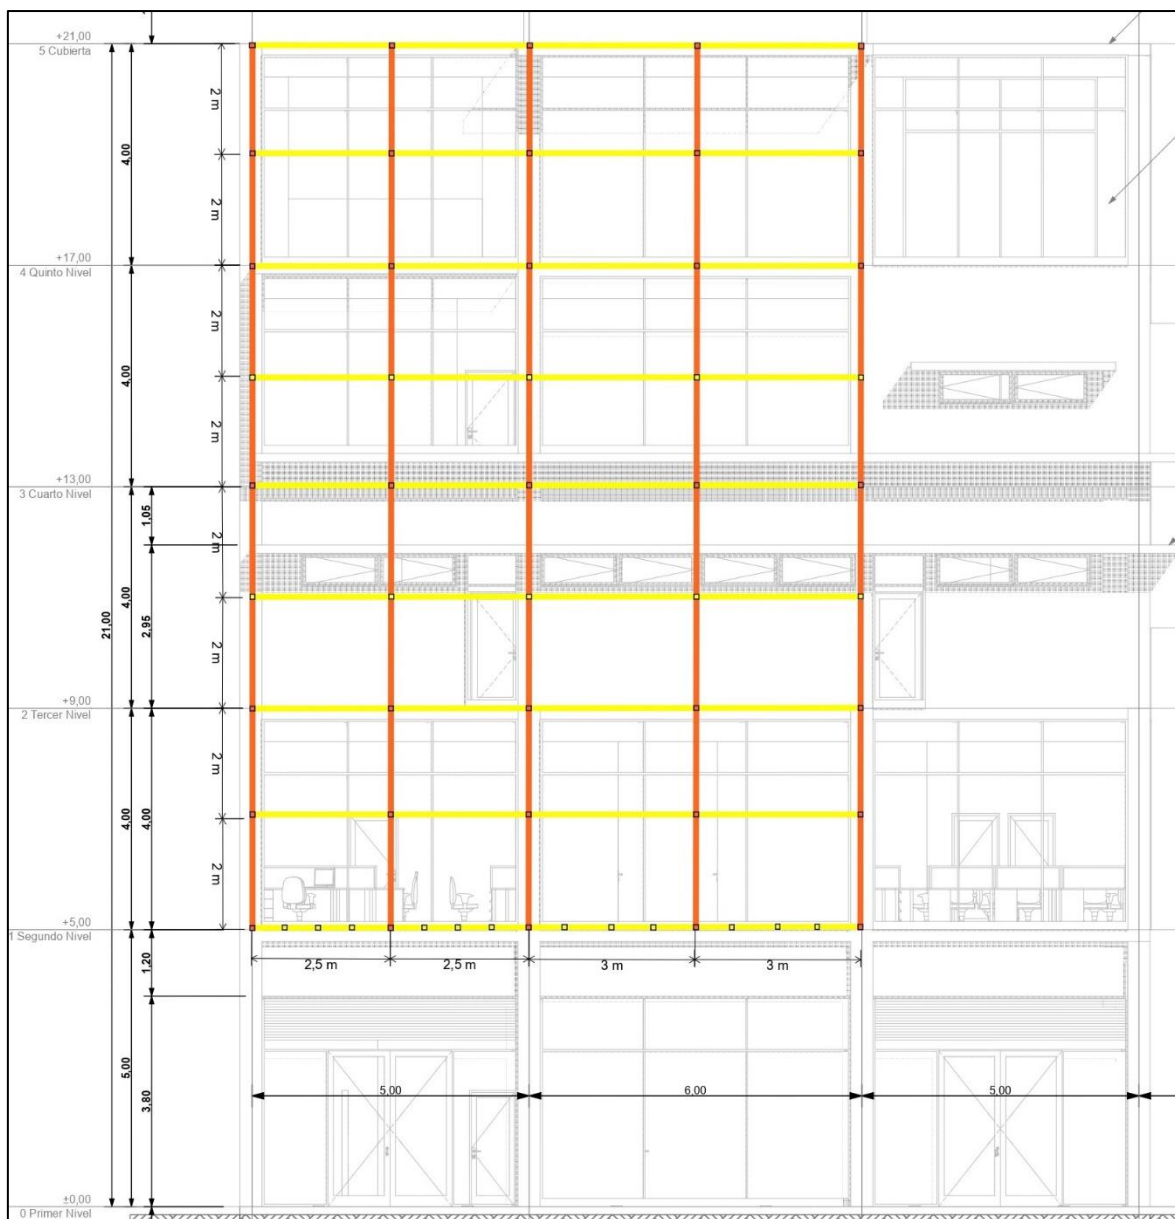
Estructura para la pared viva en la fachada Este (principal)
